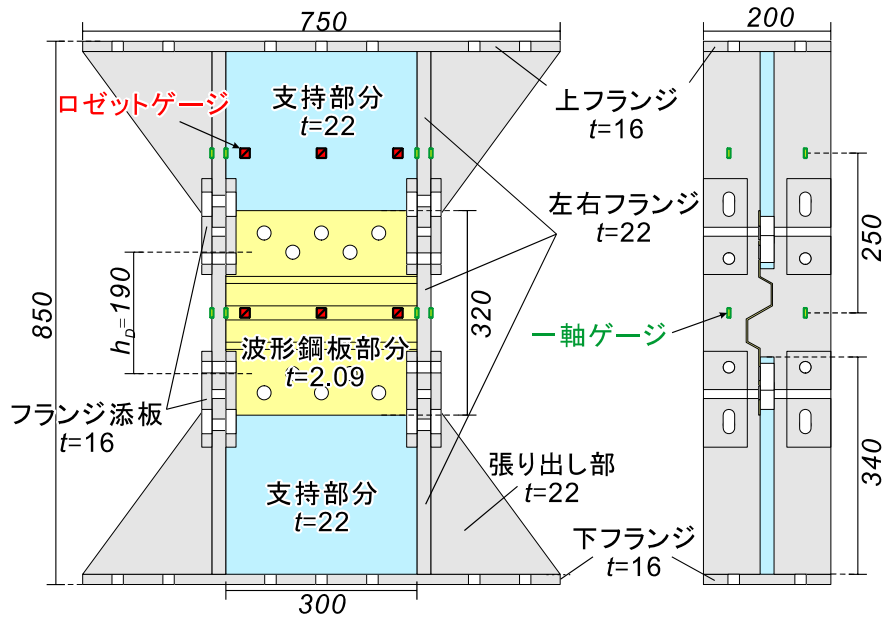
波形鋼板ダンパー詳細 (単位 : mm)
